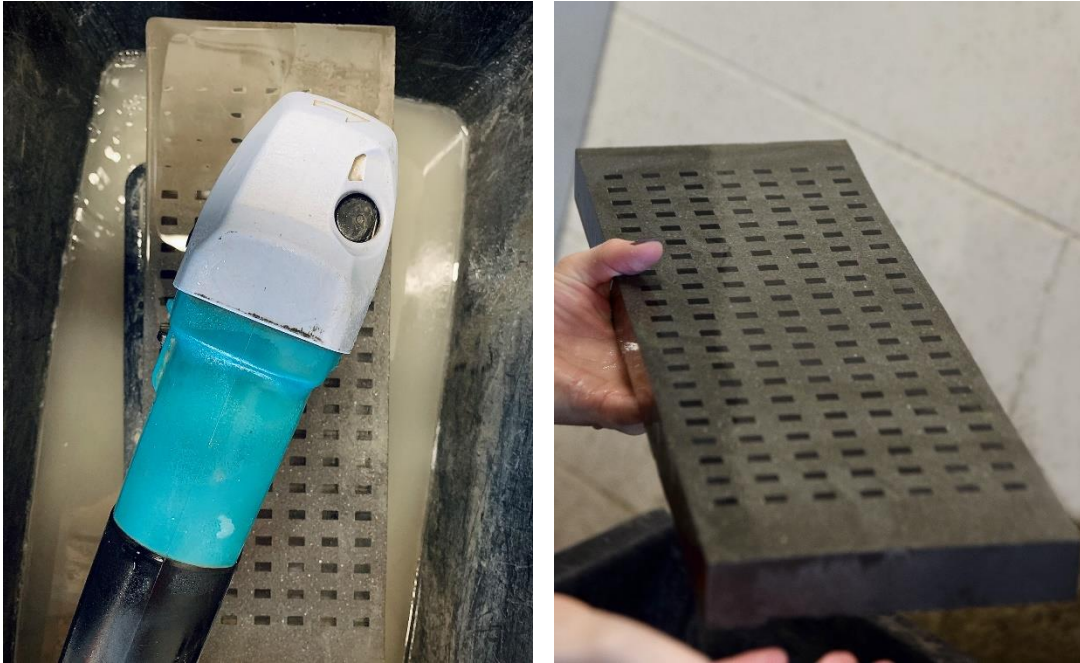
Výroba vzorků průsvitného textilního betonu
